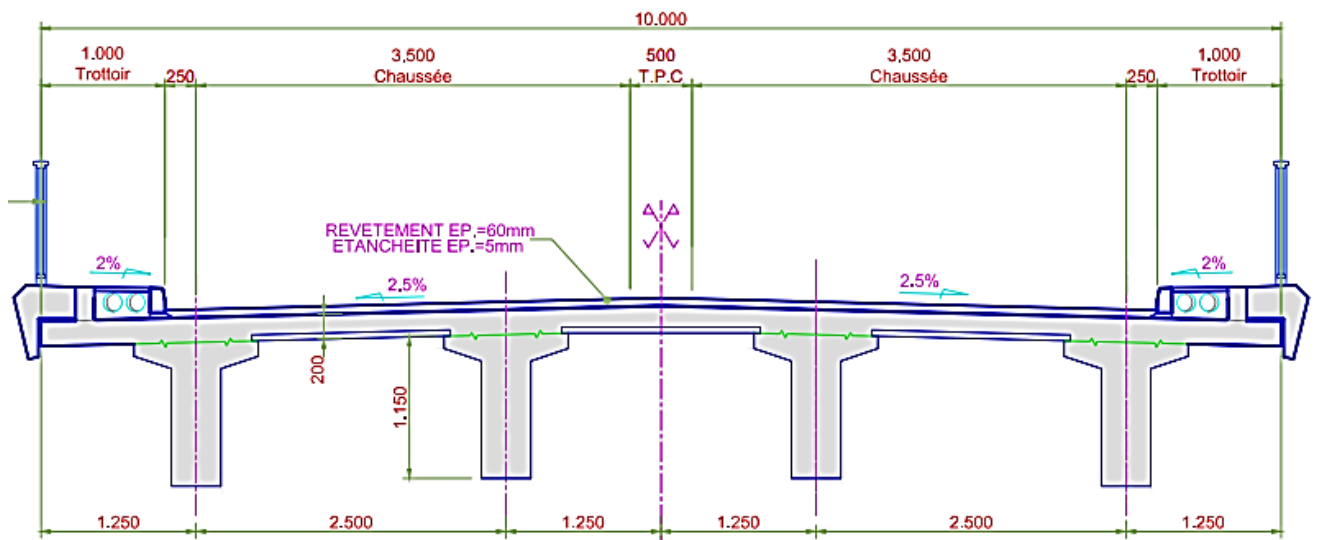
Profil en travers de l'ouvrage d'art (OA1)
